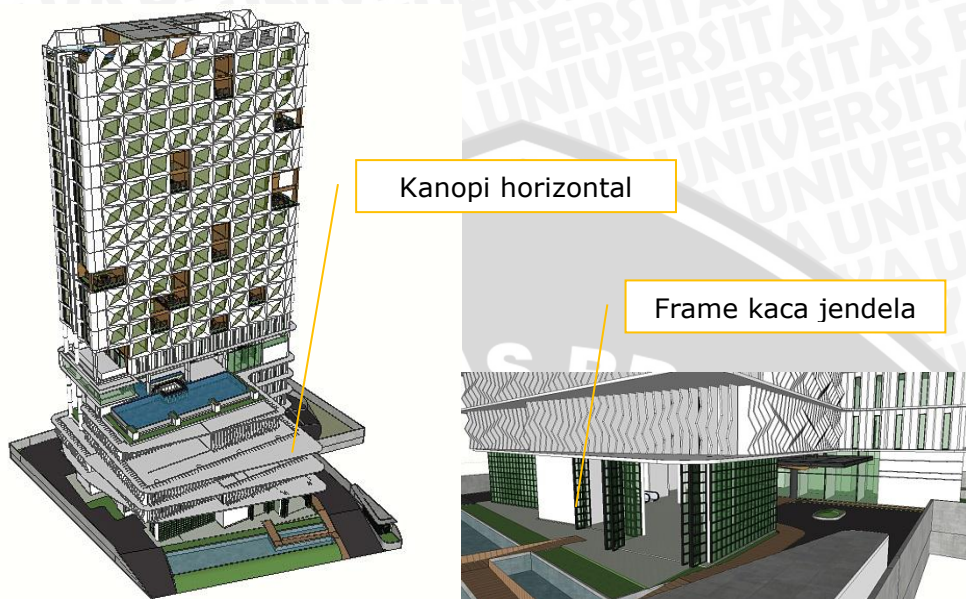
80 Pengolahan irama pada tampilan fasad bangunan
